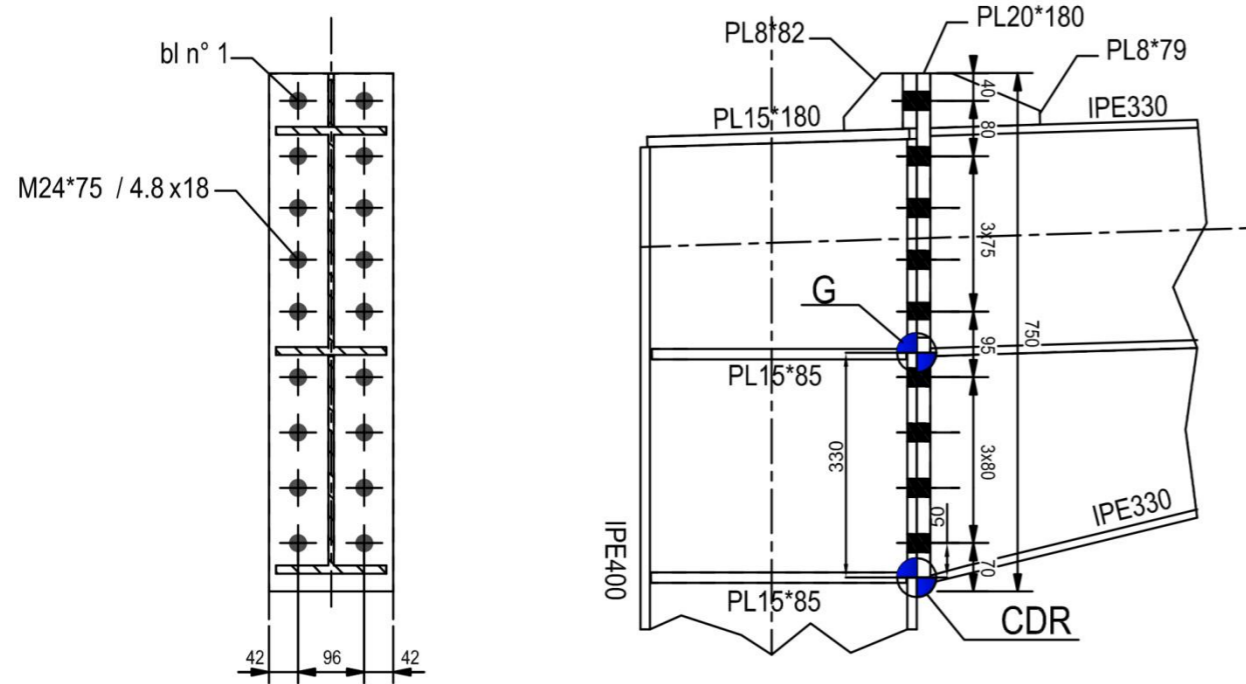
Vue de détail de la liaison Poteau-Traverse de la file 2 côté B. La liaison est un encastrement par platine d'about (PL20\*180) vissée dans la semelle du poteau (IPE 400). Deux rangées de 9 boulons (M24 de classe 4.8) assurent la transmission des efforts. Les trous de perçage sont normaux. On a indiqué la position du boulon le plus sollicité au-dessus des semelles de la traverse (bl n°1). Notez que le CDR (centre de rotation) est placé au niveau de la semelle inférieure du jarret à 50 mm de la plus basse ligne de boulons.
